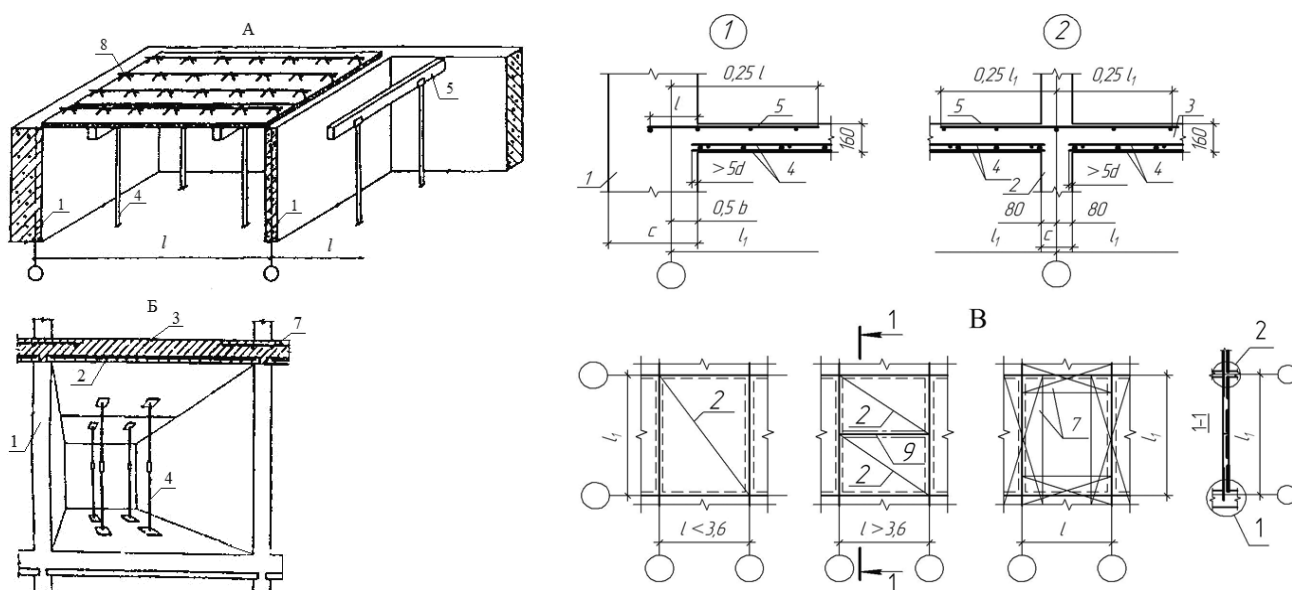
А – установка плоских железобетонных скорлуп, выполняющих роль несъемной опалубки; Б – замоноличивание плиты; В – схема раскладки скорлуп и верхних арматурных сеток:
